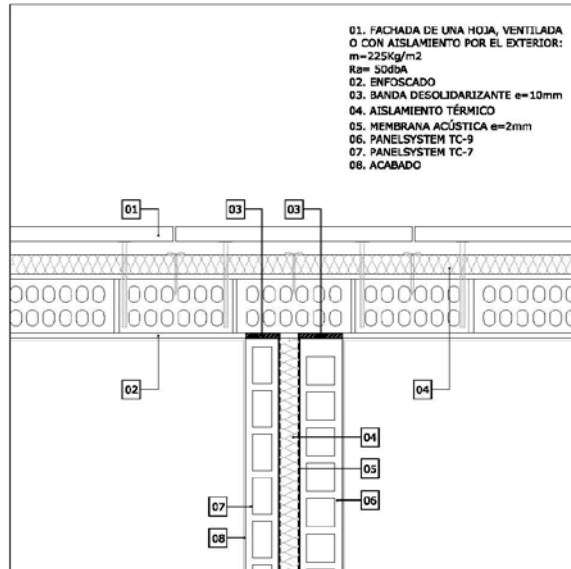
SECCIÓN HORIZONTAL DE ENCUENTRO CON FACHADA, CON TRASDOSADO AL INTERIOR
